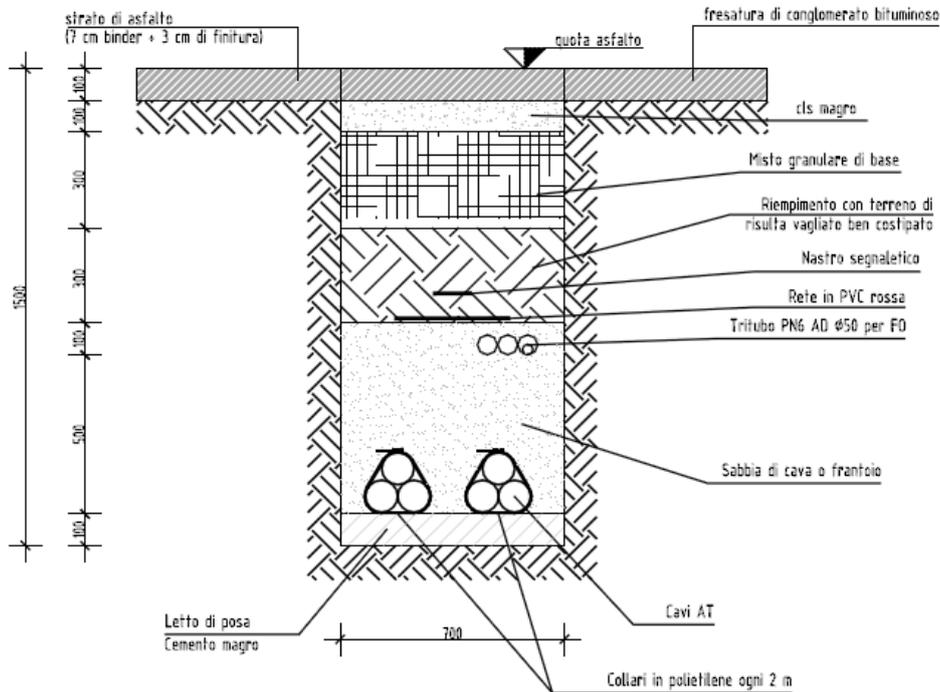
Sezione tipica cavidotto esterno su strada asfaltata (2 terne)
